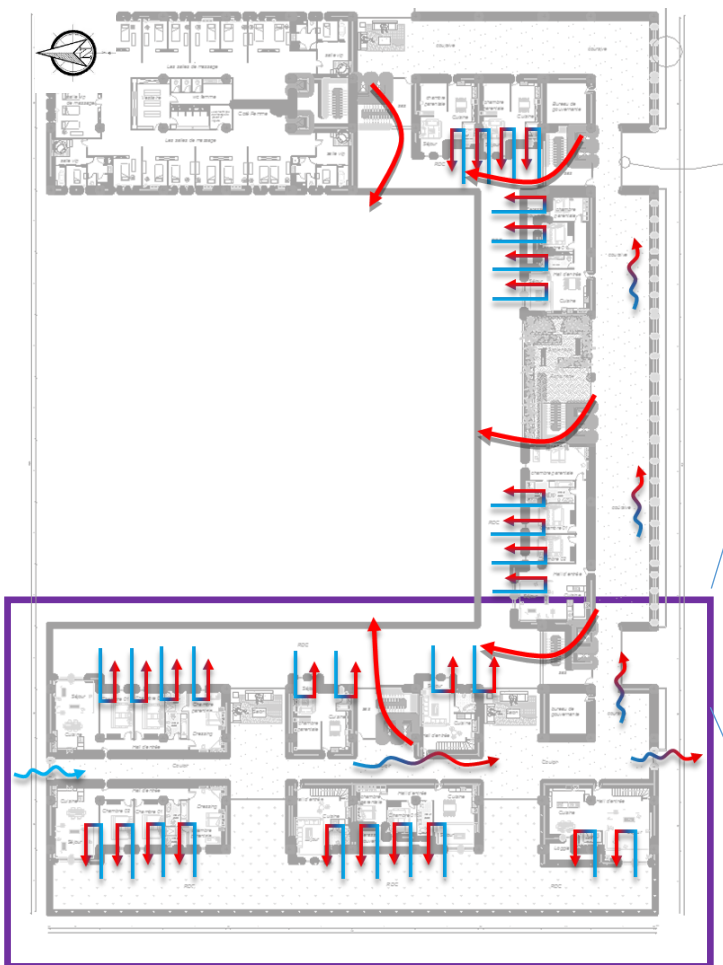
schématisation en plan Ventilation Naturelle unilatérale et transversale
